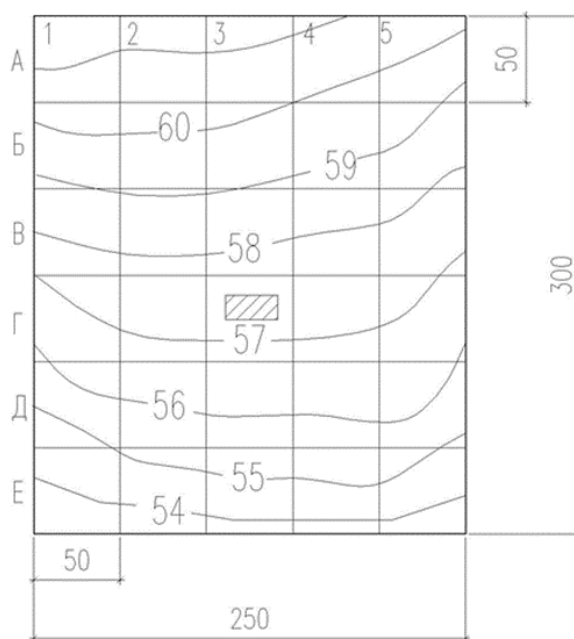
Схема строительной площадки (размеры указаны в м) с местоположением котлована в квадрате Г-4.
